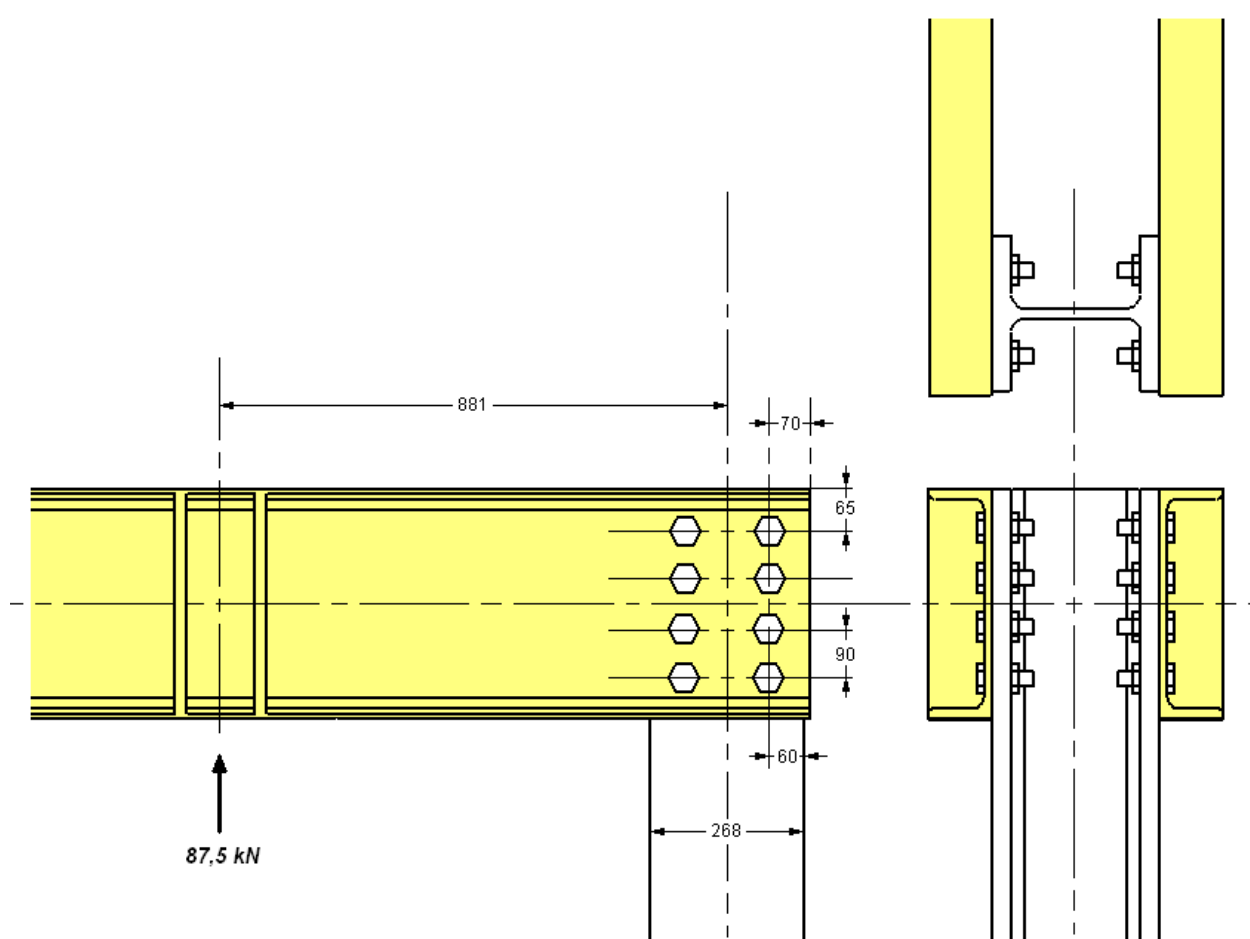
Ligação aparafusada entre as vigas superiores e a coluna
